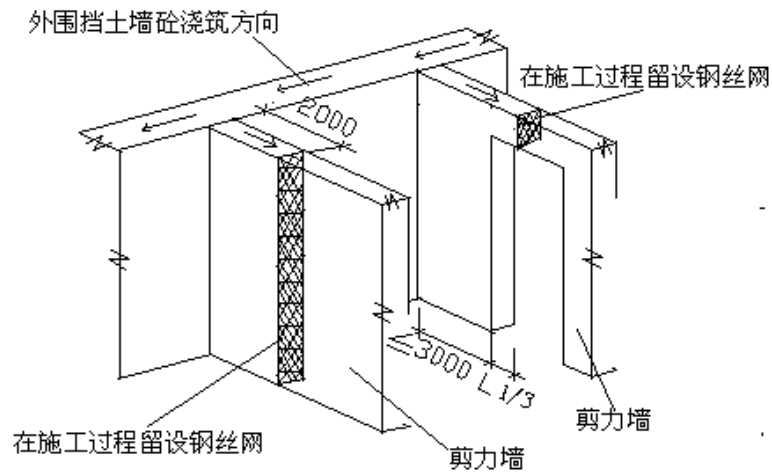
地下室内剪力墙施工缝留置位置示意图
